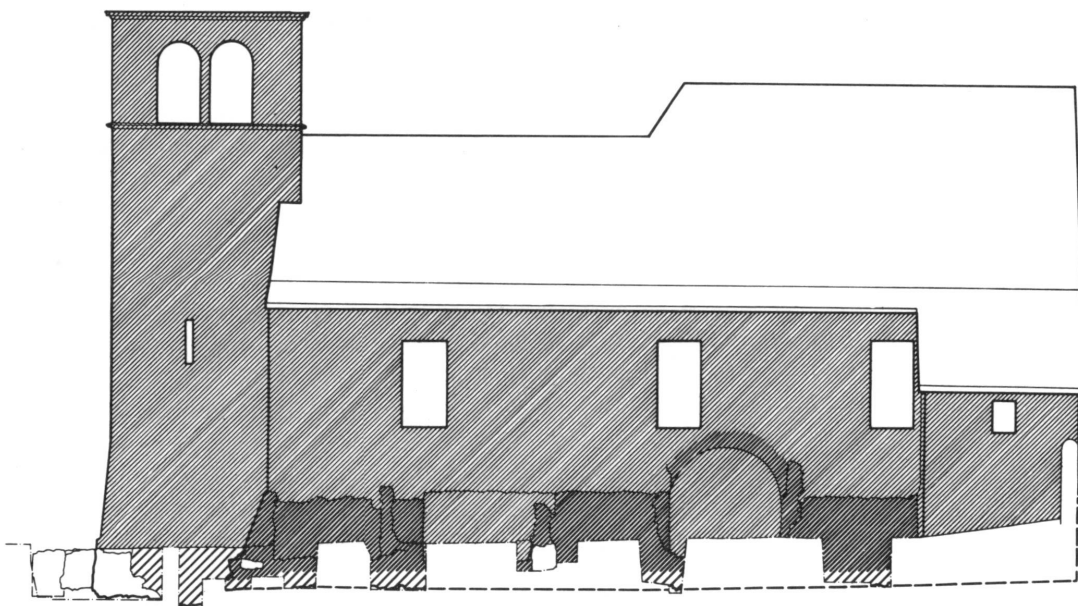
Eglise de 1679. Schéma des élévations du mur sud. Echelle 1 : 250.
